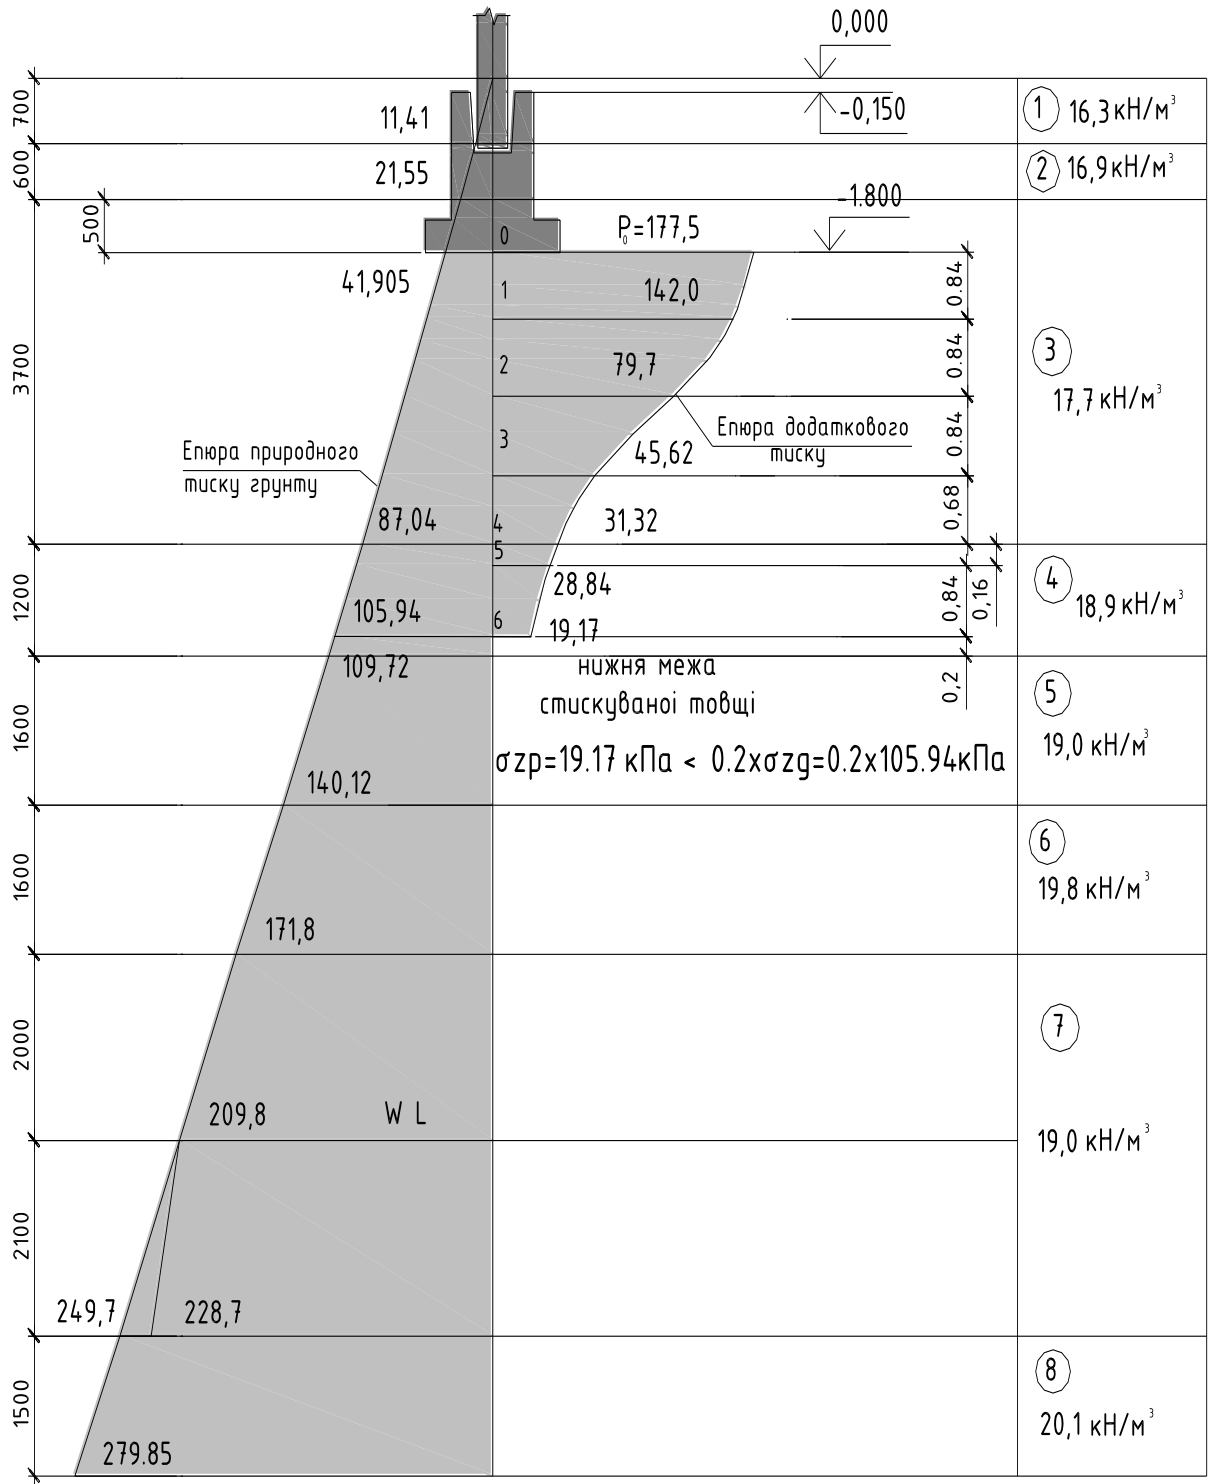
Схема до розрахунку осідання фундаменту
